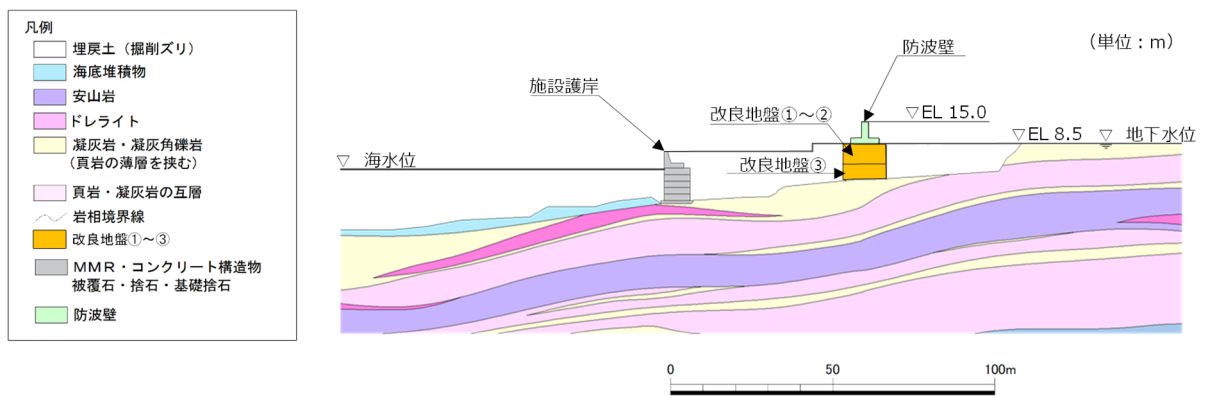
防波壁 (逆 T 擁壁) の横断面図 (⑥-⑥断面)
